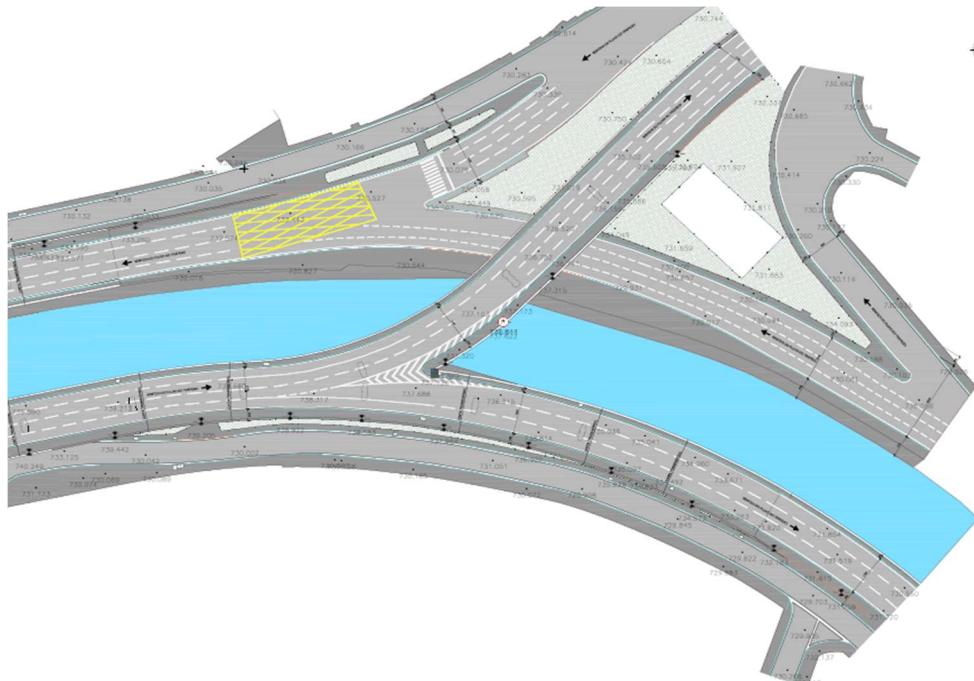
Detalhe de Planta Geral de Obra de Arte (Vista Superior) elaborada mediante utilização da técnica de Escaneamento a Laser
